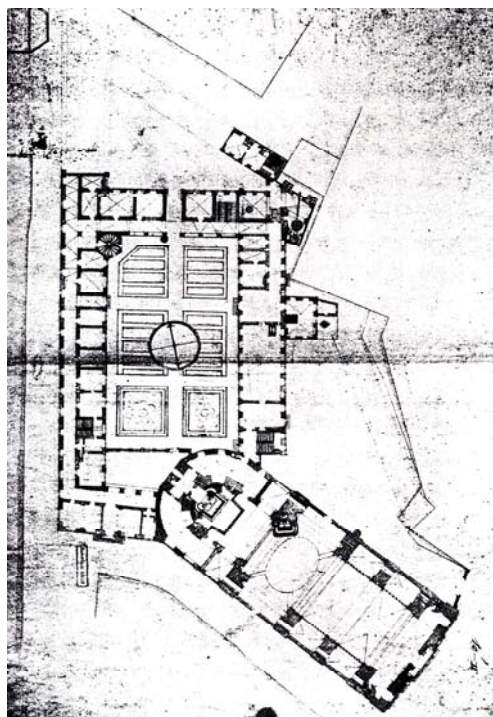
Bamberg, St. Martin, Grundriss um 1708
